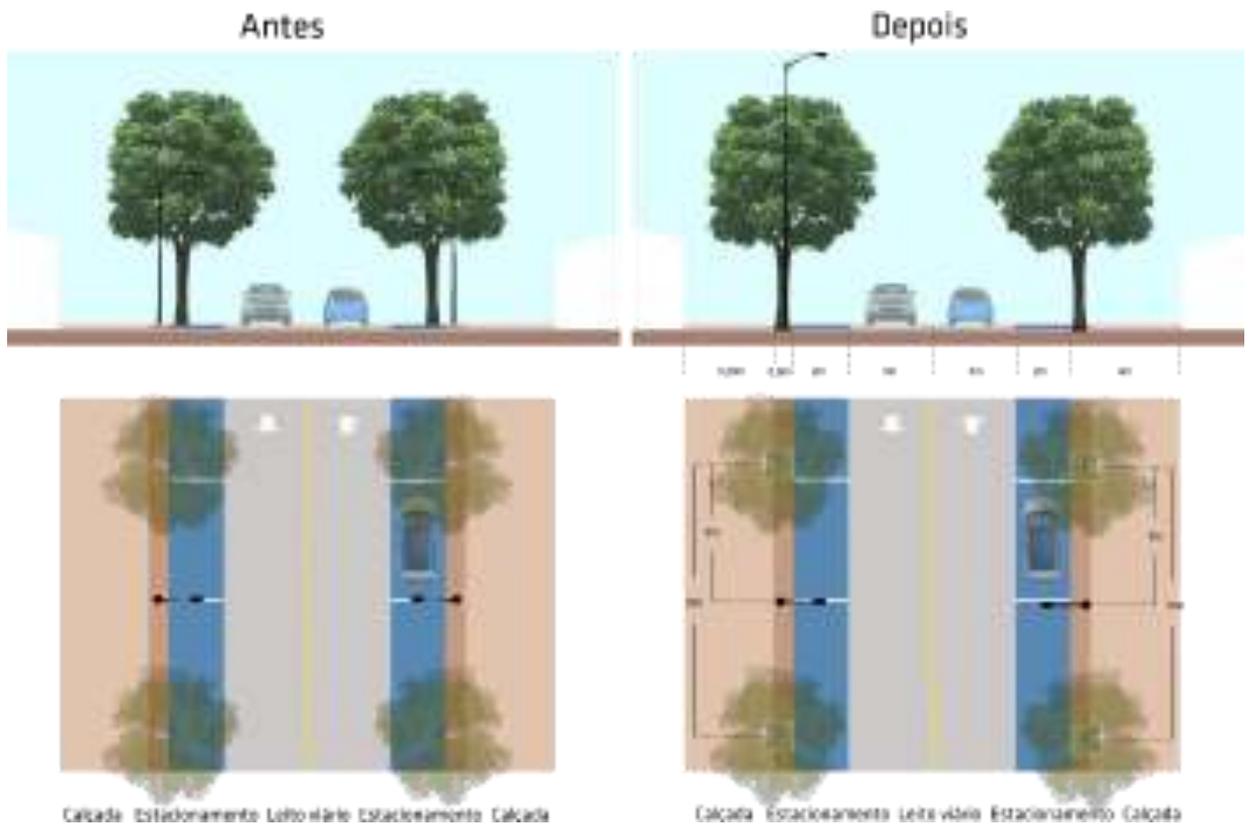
Proposta para a Seção G, Rua Major Franco. Fonte: Architectus.
